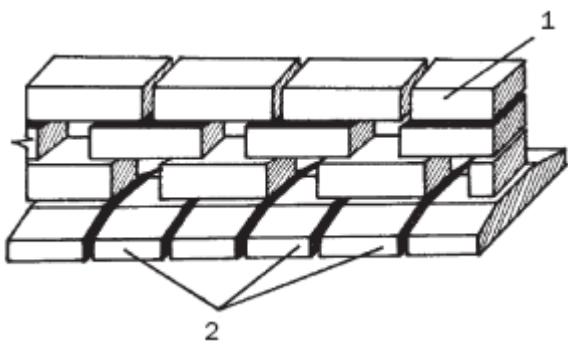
Ленточный фундамент с разрывами: 1 – фундаментные блоки; 2 – блоки подушки
